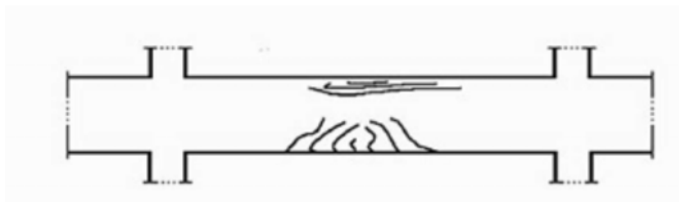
Fissuração em viga submetida a flexocompressão.
